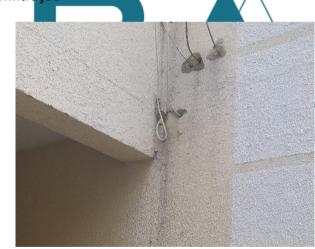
Fissuras externa - ponto de infiltração
